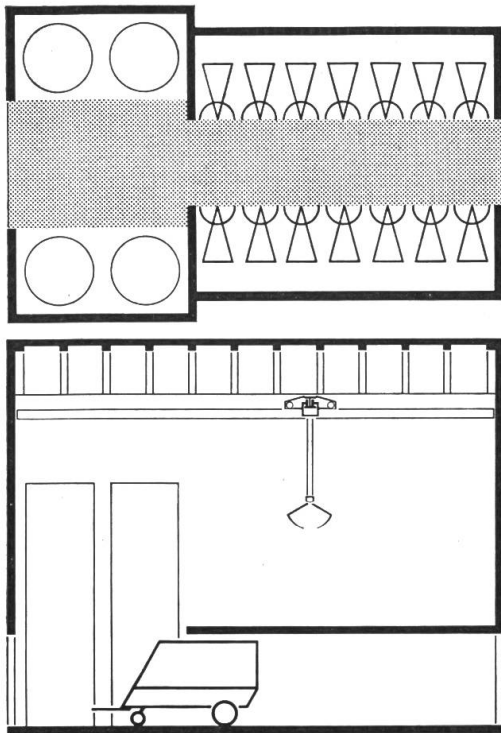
Deckenlastige Lagerung mit gemeinsamer Futter- und Erntedurchfahrt, ebenes Gelände.
